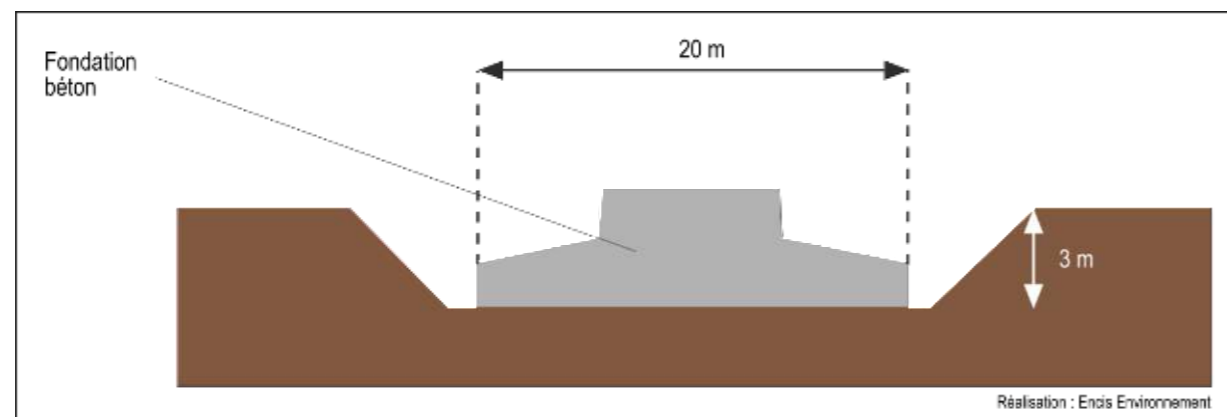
Schéma type d'une fondation d'éolienne V117 HH91,5
